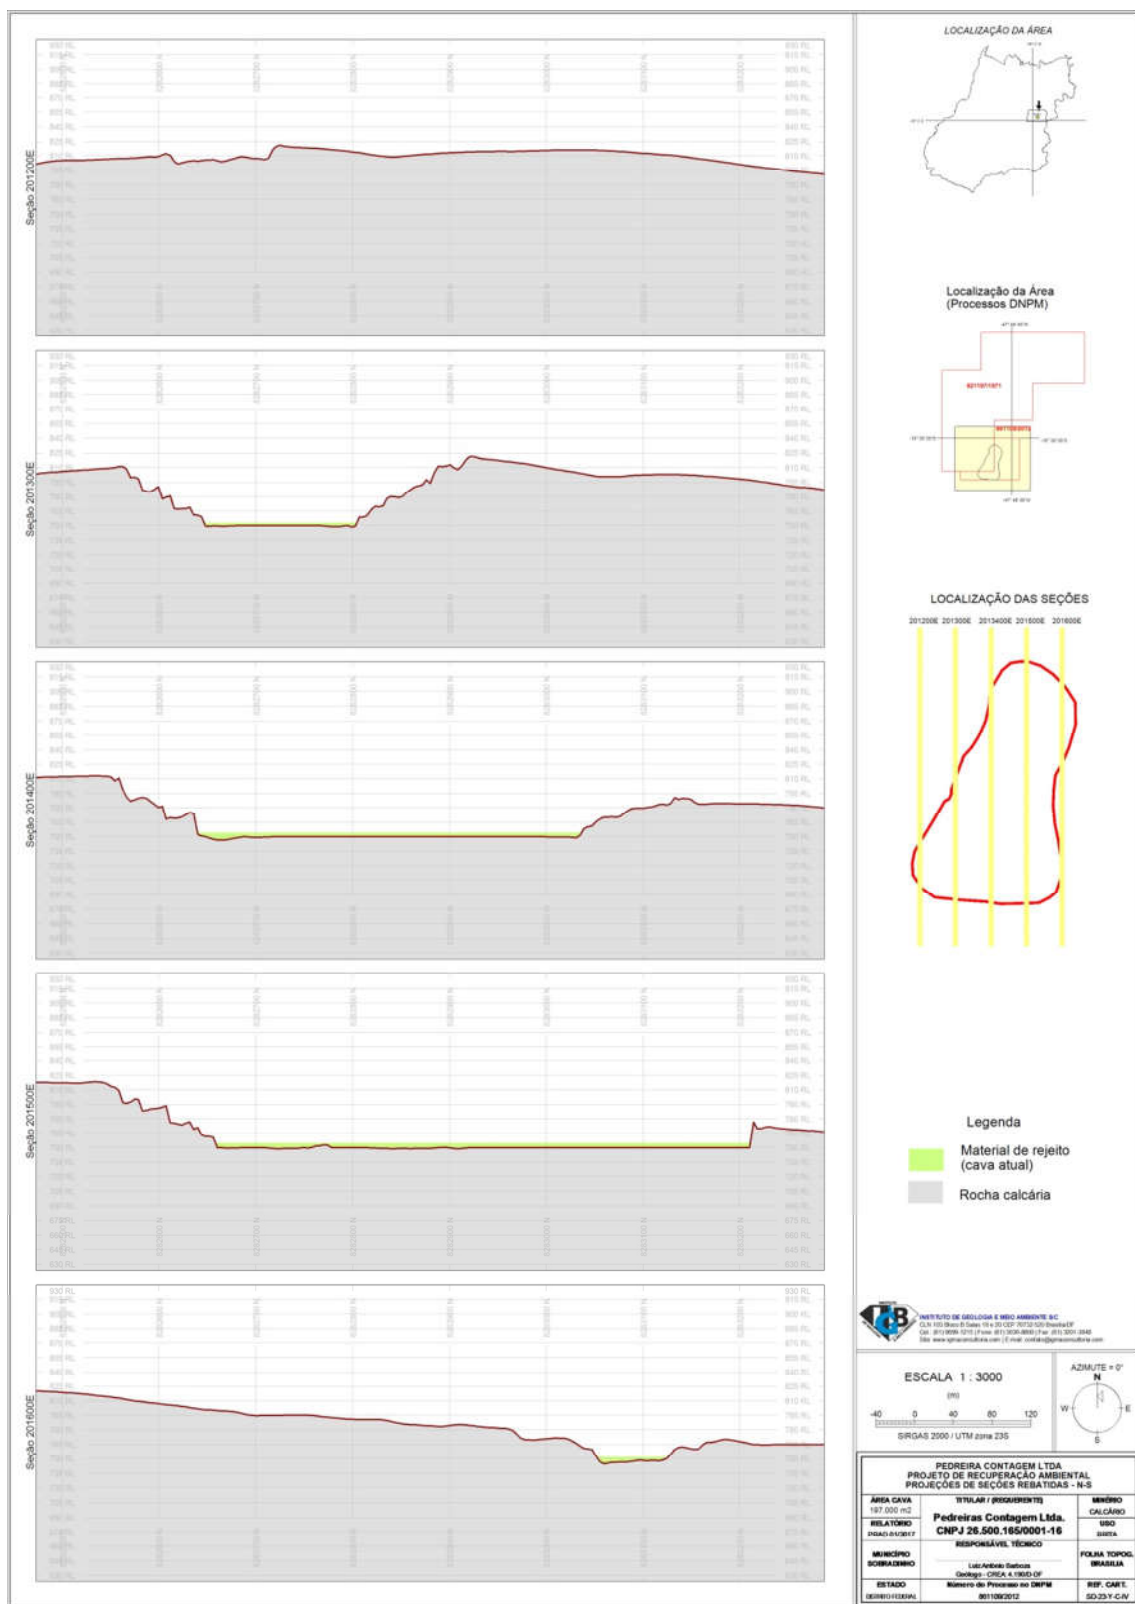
Figura: Processo DNPM 821.197/1971 – seções verticais rebatidas Sul-Norte, demonstrando preenchimento com estéril armazenado.
